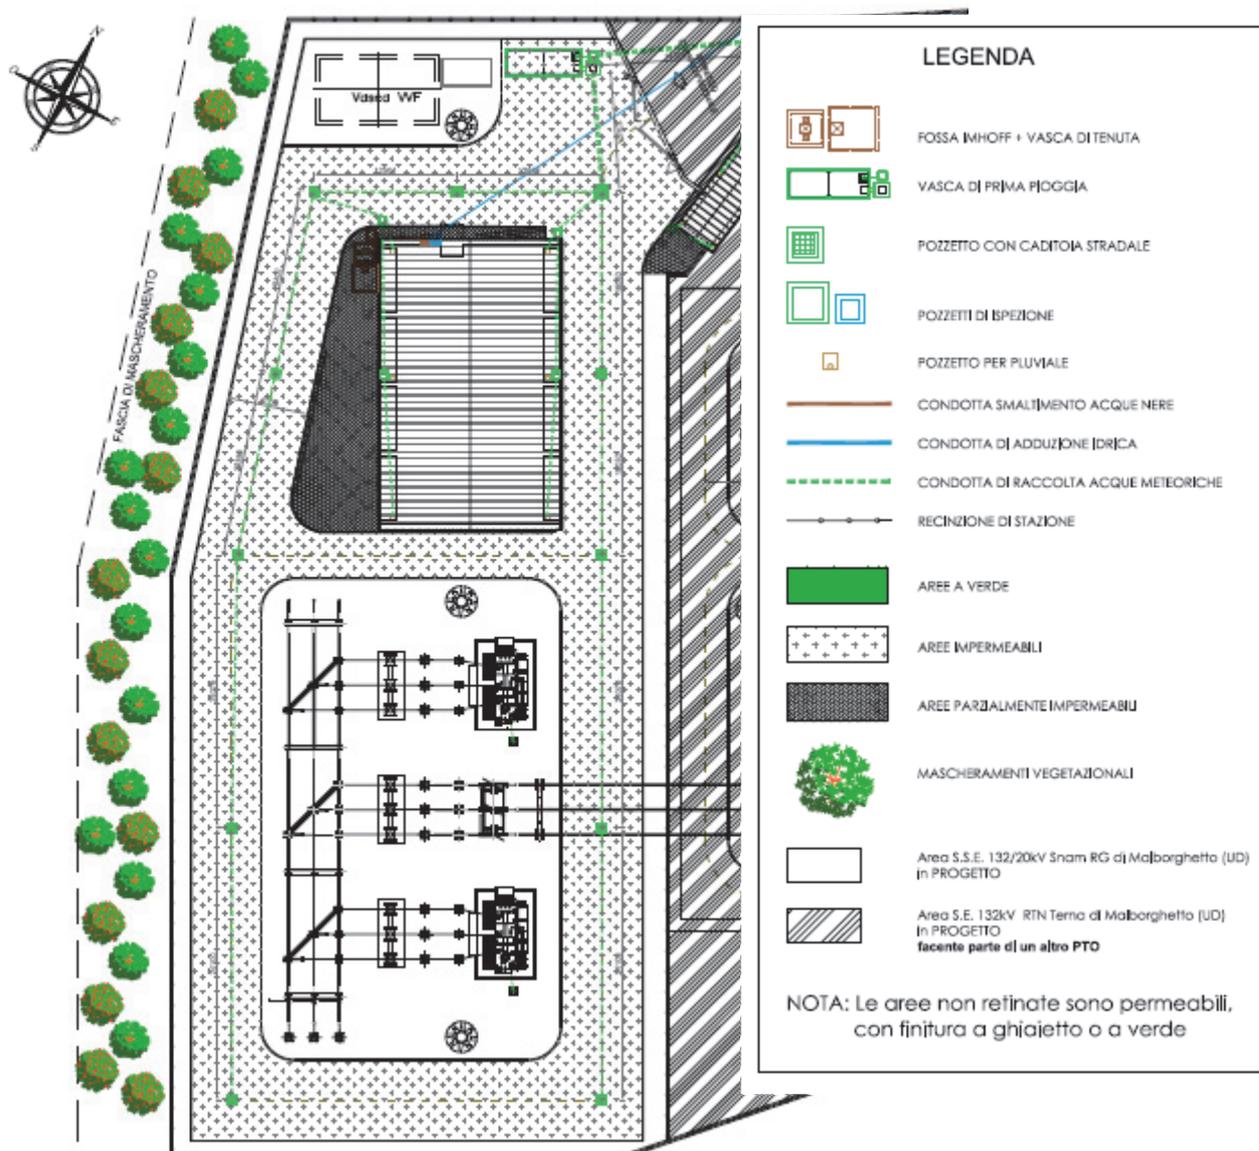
Planimetria sottostazione Elettrica d'utente AT/MT Terna
